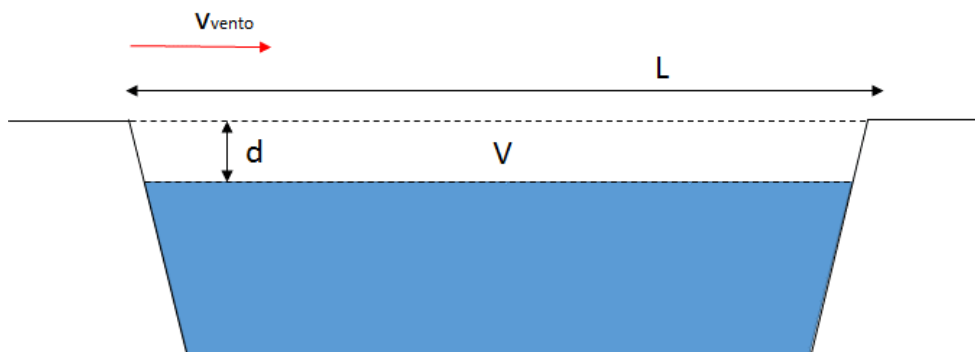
Specchio d'acqua in cave e/o cantieri con escavazione in zona saturata
